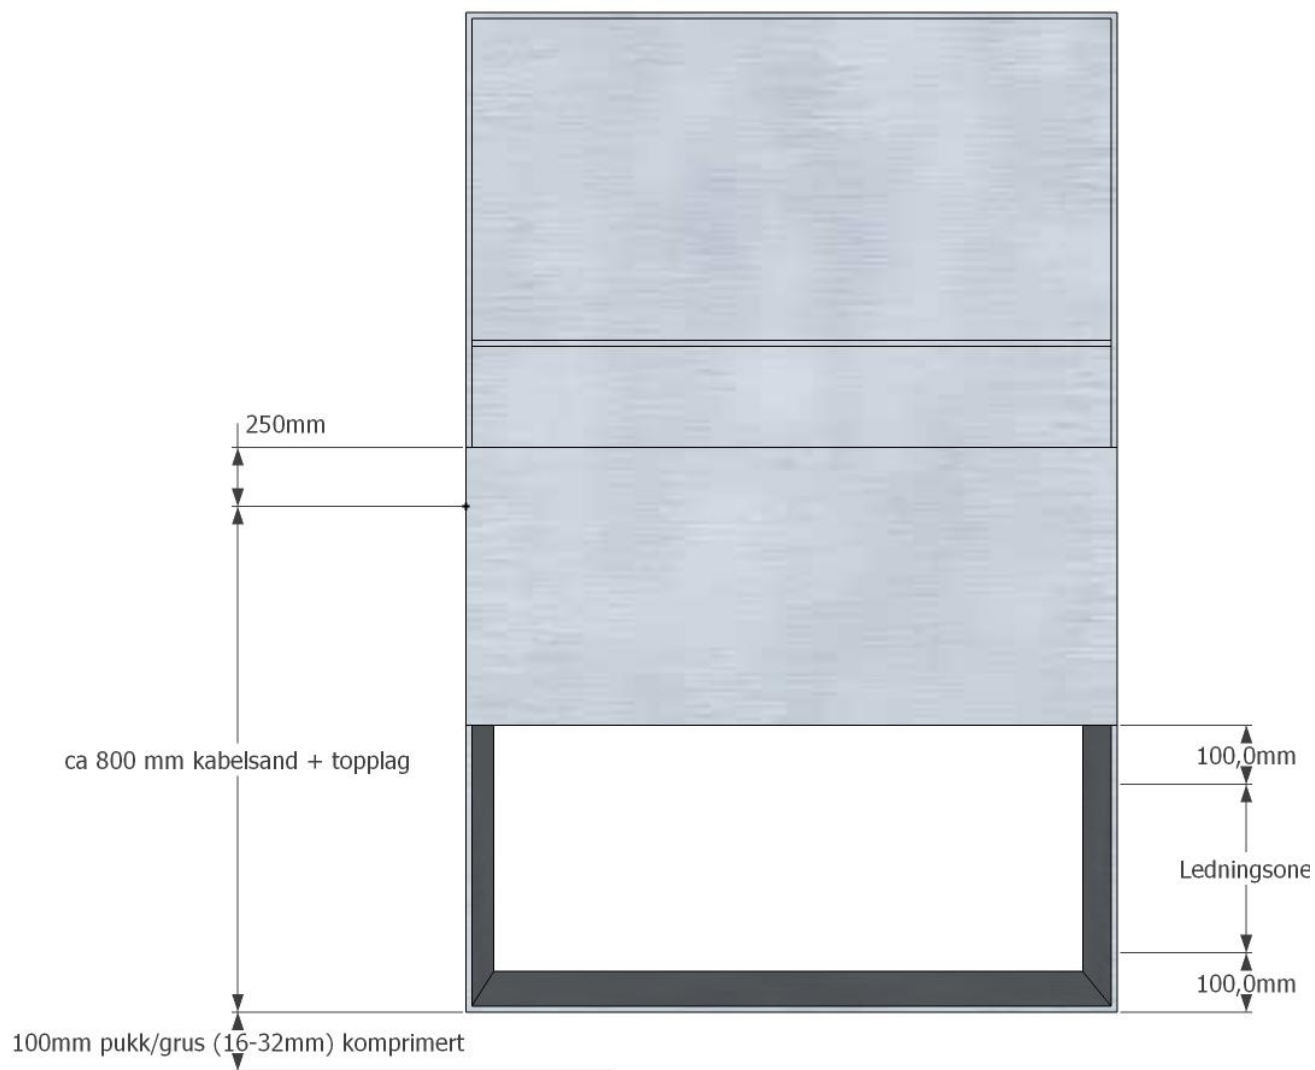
Skisse av fundament til betong nettstasjon MINI-A
